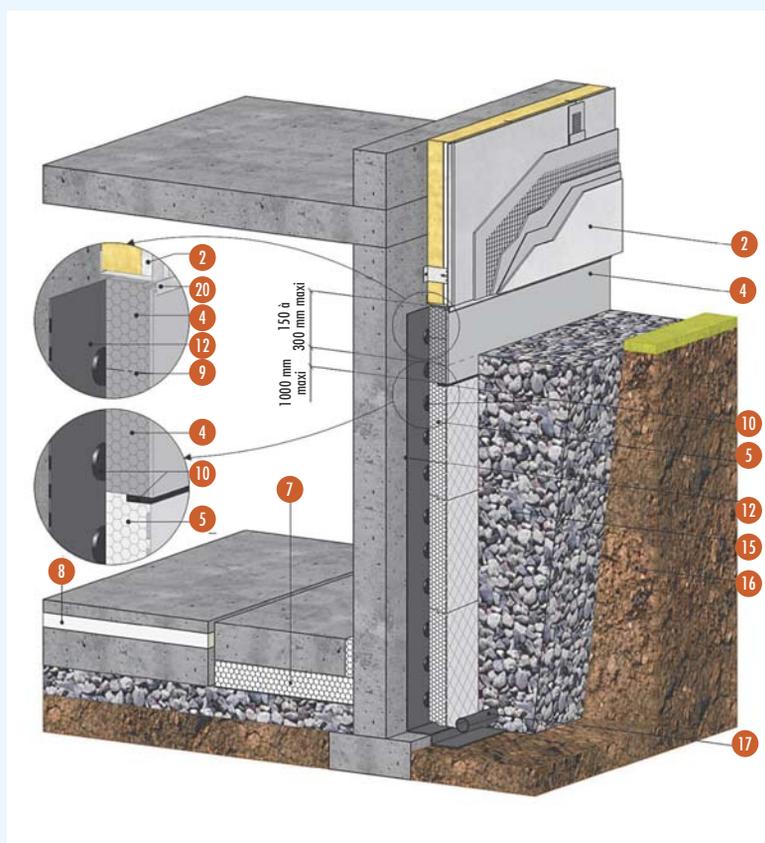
Exemple de mur enterré isolé sur fondation de Catégorie 1 avec bardage ventilé, Knauf Therm Périgoard® Ultra 30 SE et Knauf Therm Perimaxx®
